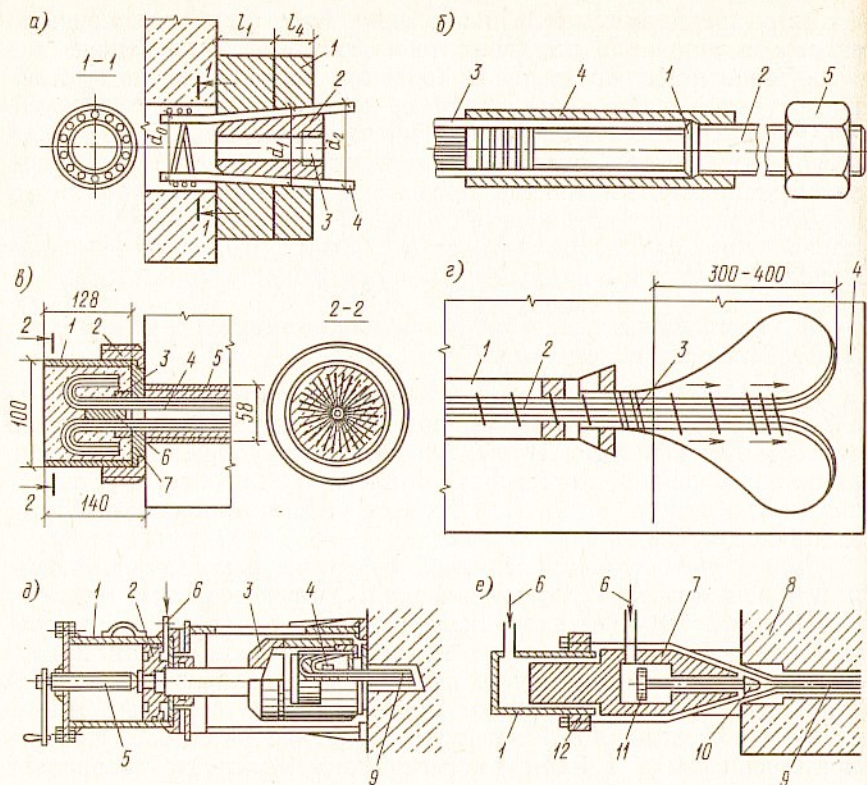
Приспособления для закрепления и натяжения пучковой арматуры
